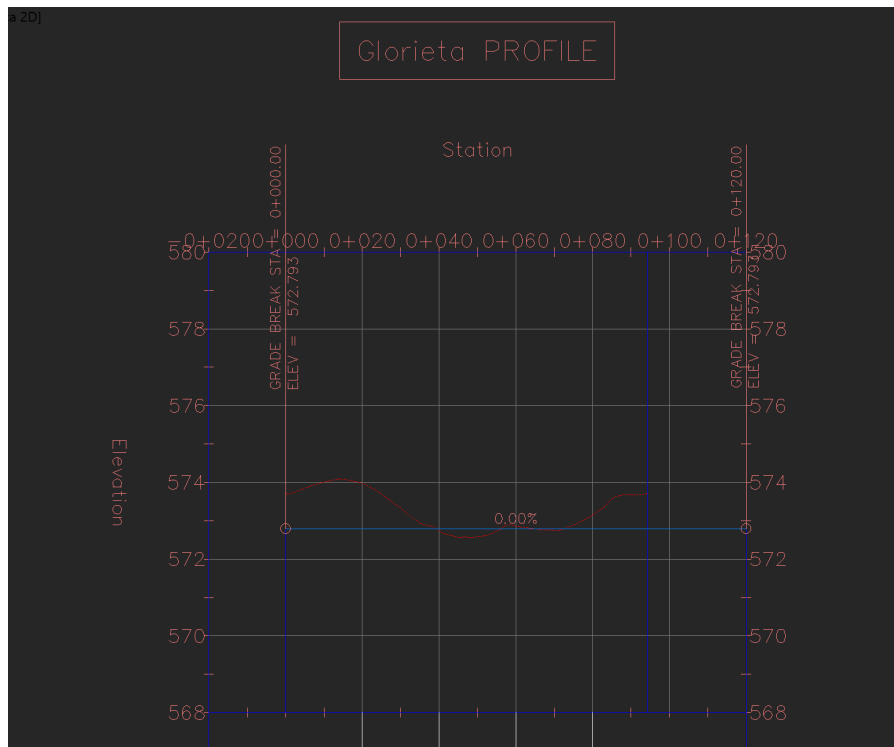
Alzado glorieta. Fuente: Elaboración propia.
